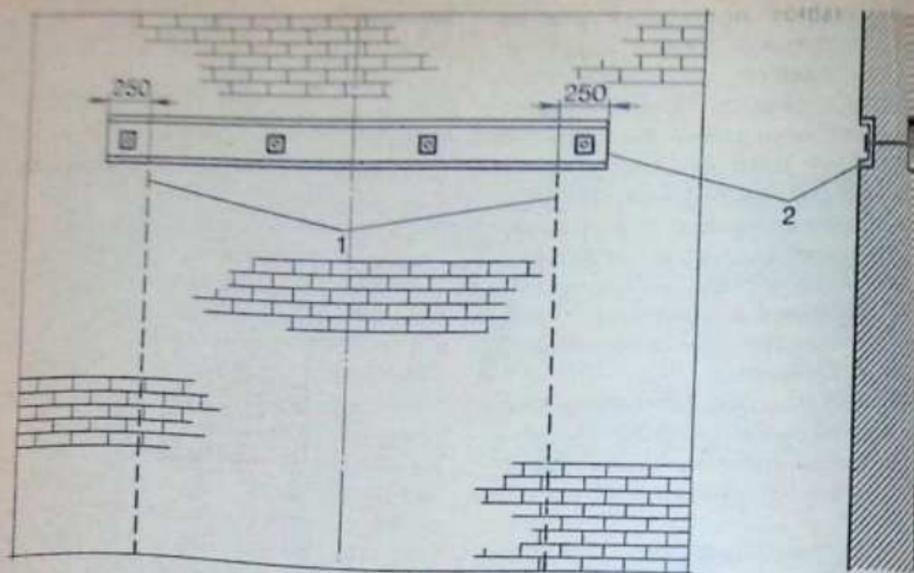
Схема закладки стальных балок перемычки при пробивке проемов в стенах: 1 — контур проема, 2 — стальная балка
